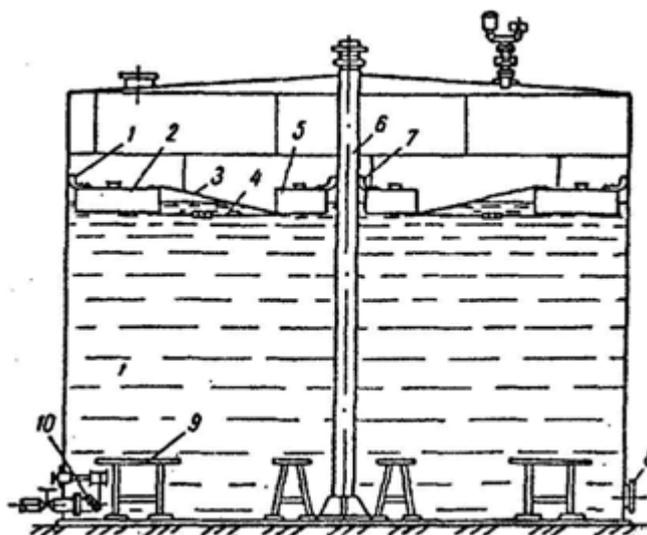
Резервуар с плавающим металлическим понтоном: 1 - уплотняющий затвор; 2 - периферийный короб понтона; 3 - мембрана из листового металла; 4 - стяжка; 5 - центральный короб понтона;
